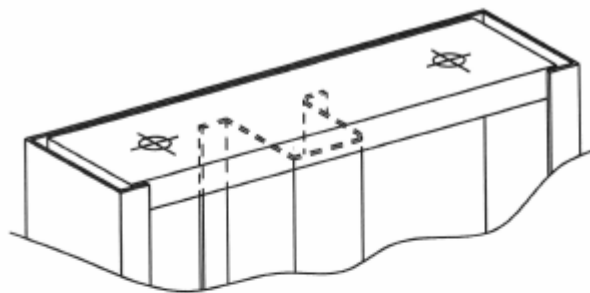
Conjunto painel bandeja com travessa maciça.
